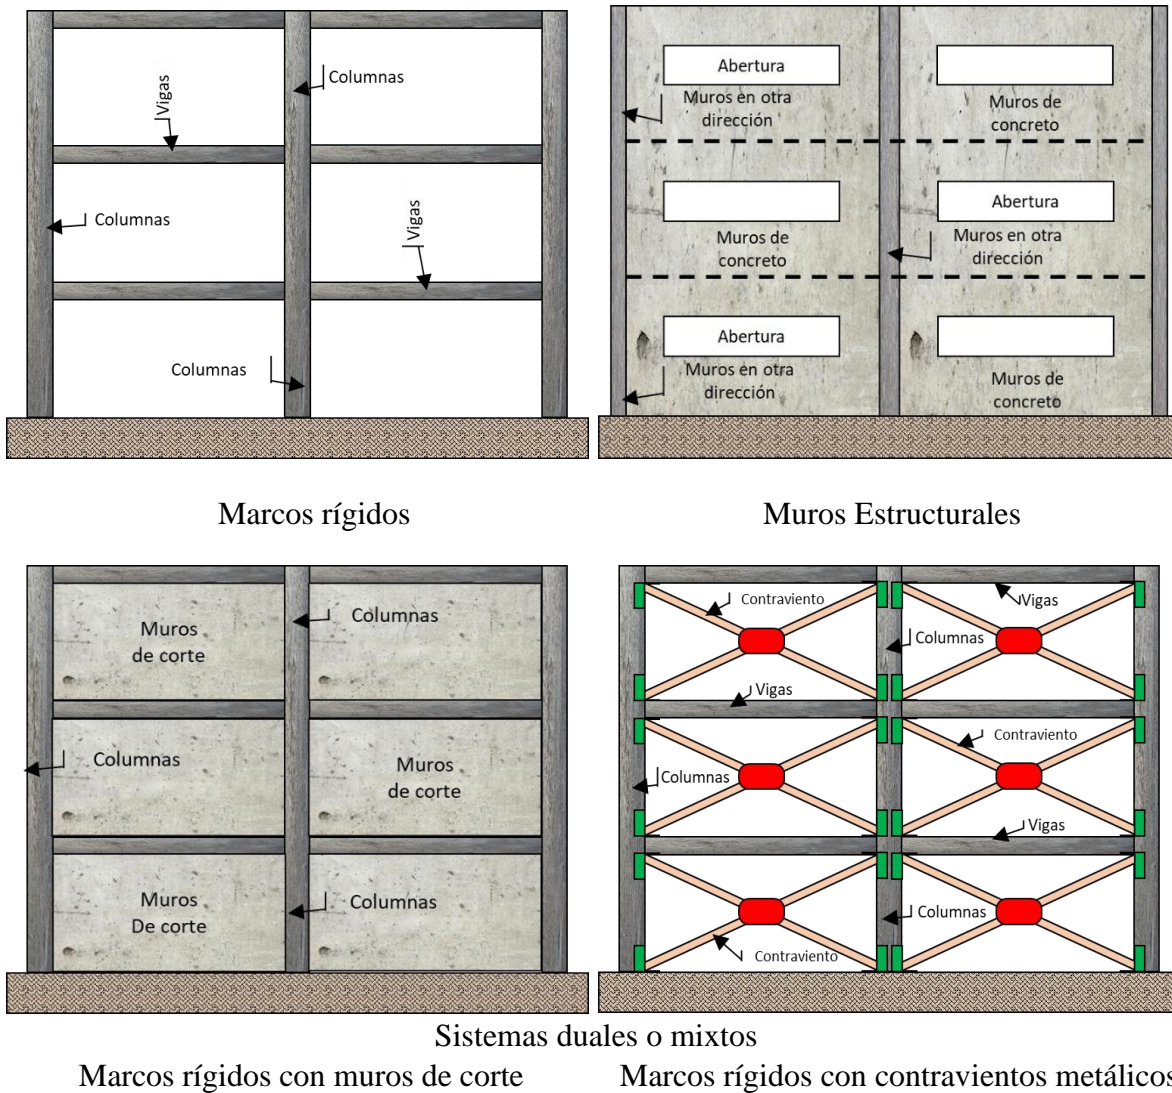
Sistemas estructurales en edificios de concreto reforzado.
